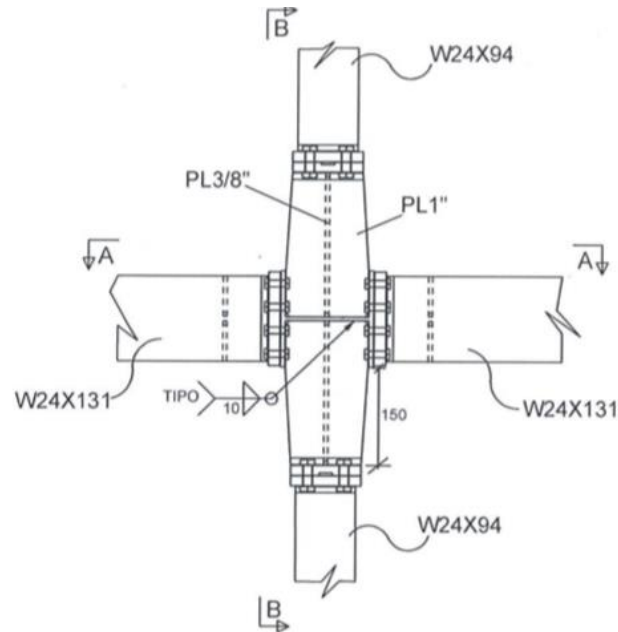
Vista en planta de conexión a columna I usada por el Grupo BAYSA S.A. de C.V.
